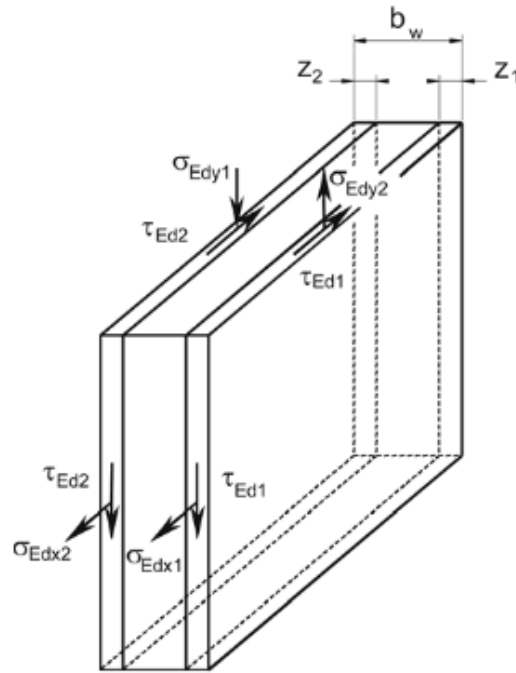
Modelo de Sandwich modificado (CEN, 2004)
